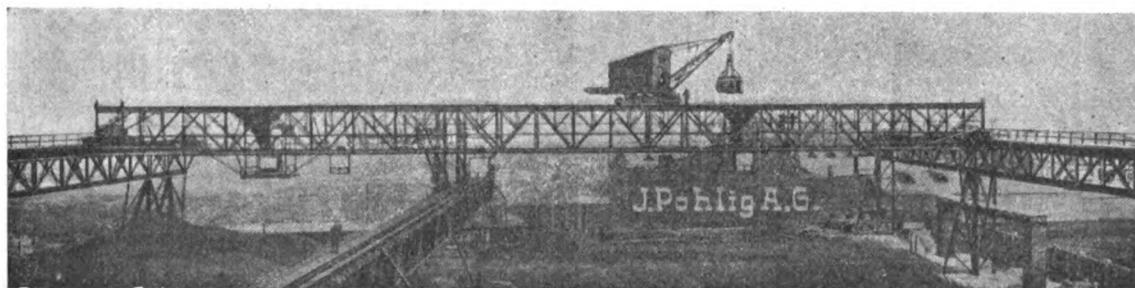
Piazzale di deposito con elettrovia e cavalletti con gru girevole, a Pietrogrado.
